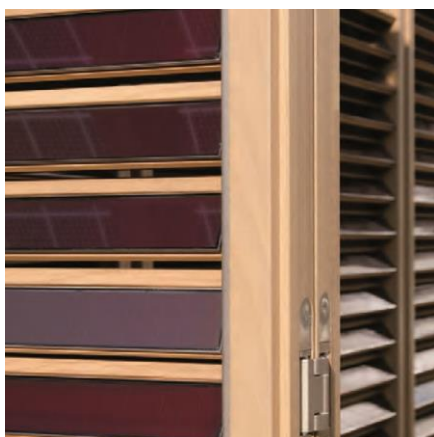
Detail Holzläden mit farblich angepassten PV-Lamellen
